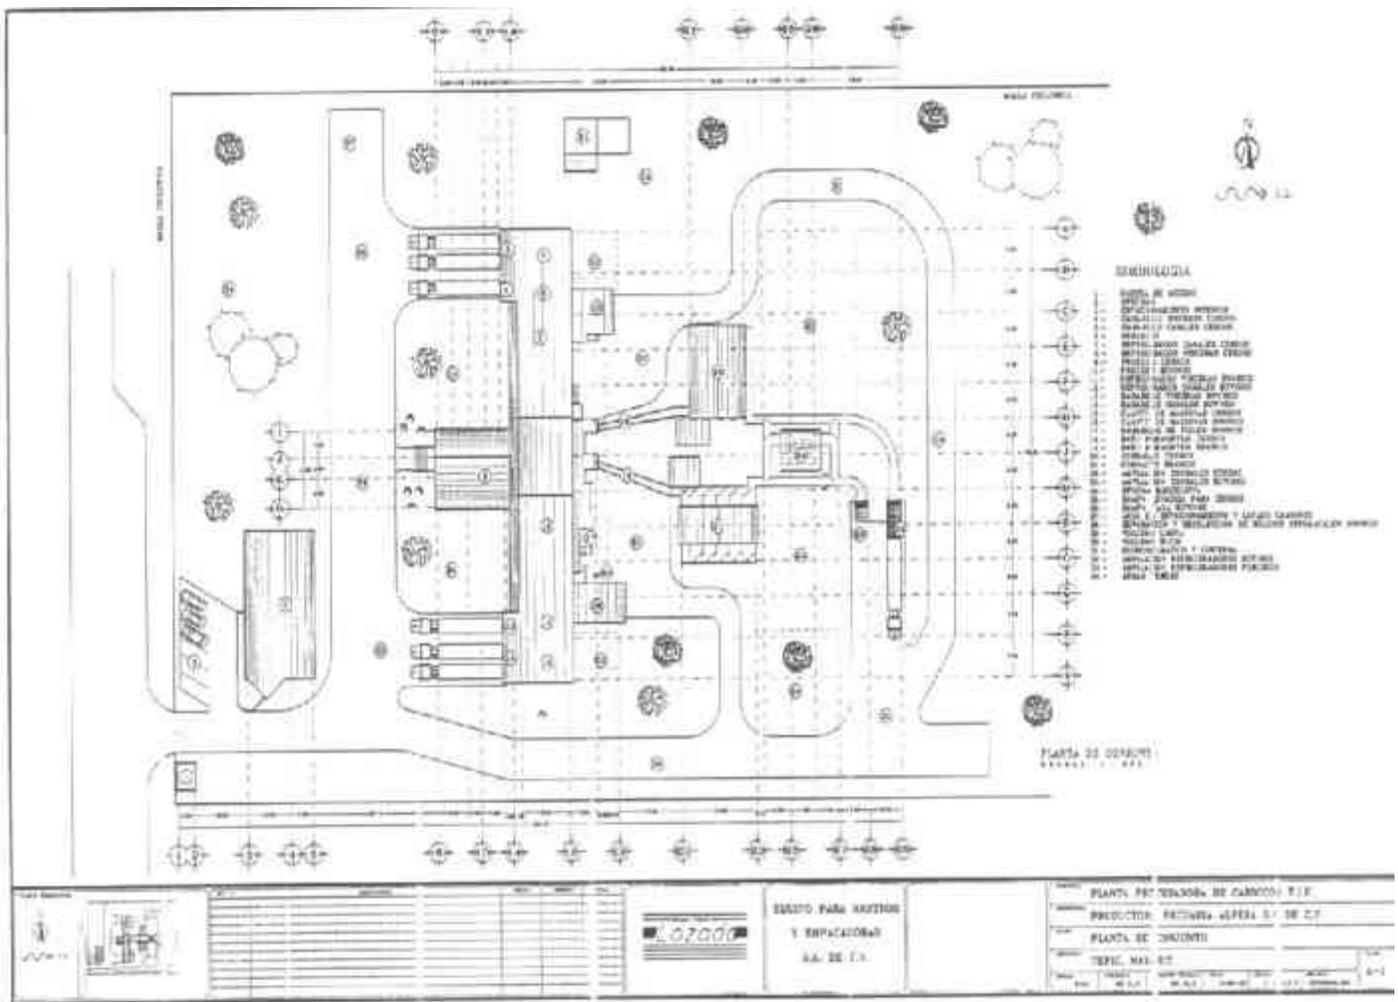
Planos de construcción (plano de conjunto).Productora Pecuaria ALpera S.A. DE C.V. /29-07-2014.
